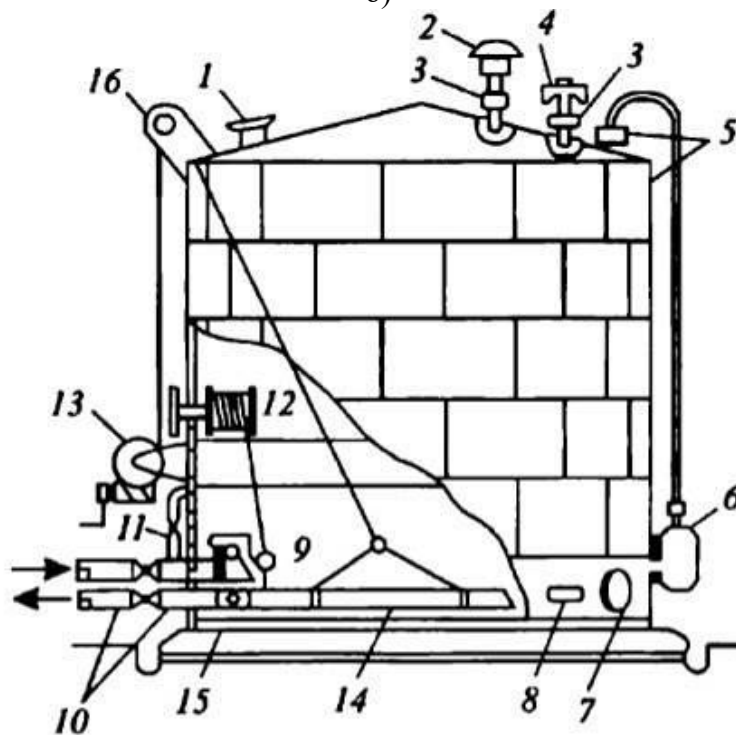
Вертикальний циліндричний резервуар низького тиску:
